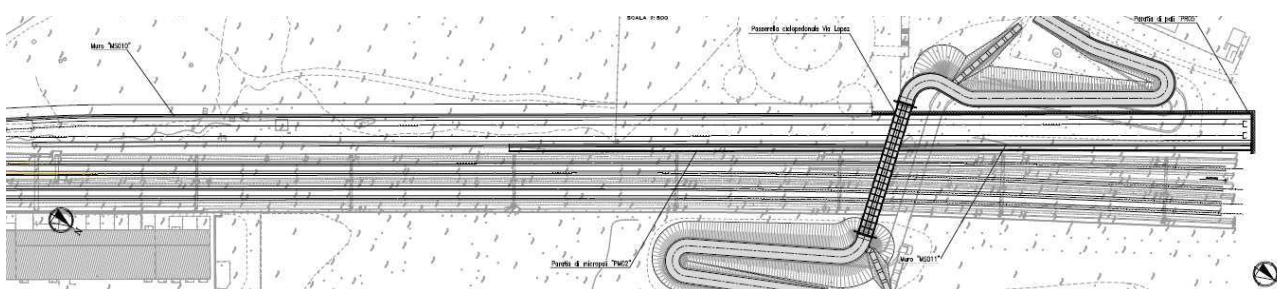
Planimetria di progetto (Ciclo-pedonale di via Lopez – fine intervento)
